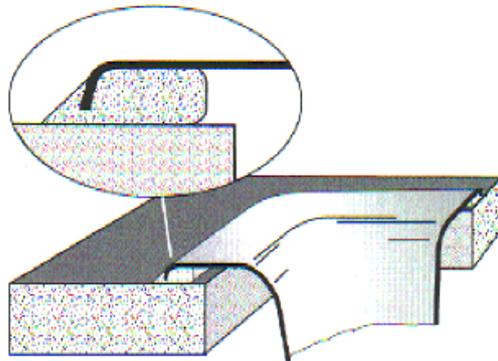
Abdichtung mit untergelegtem Dichtungsprofil
